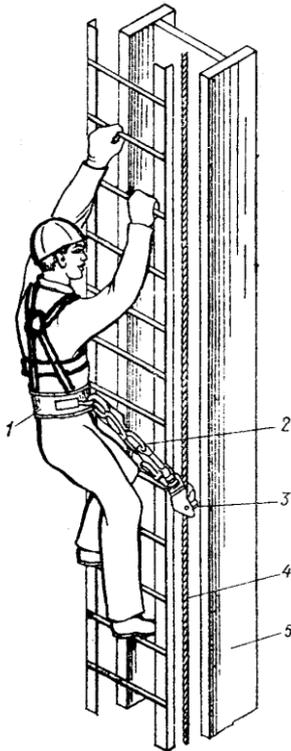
Схема безопасной организации движения работника по навесным металлическим лестницам, с использованием ловителя и вертикального каната.
